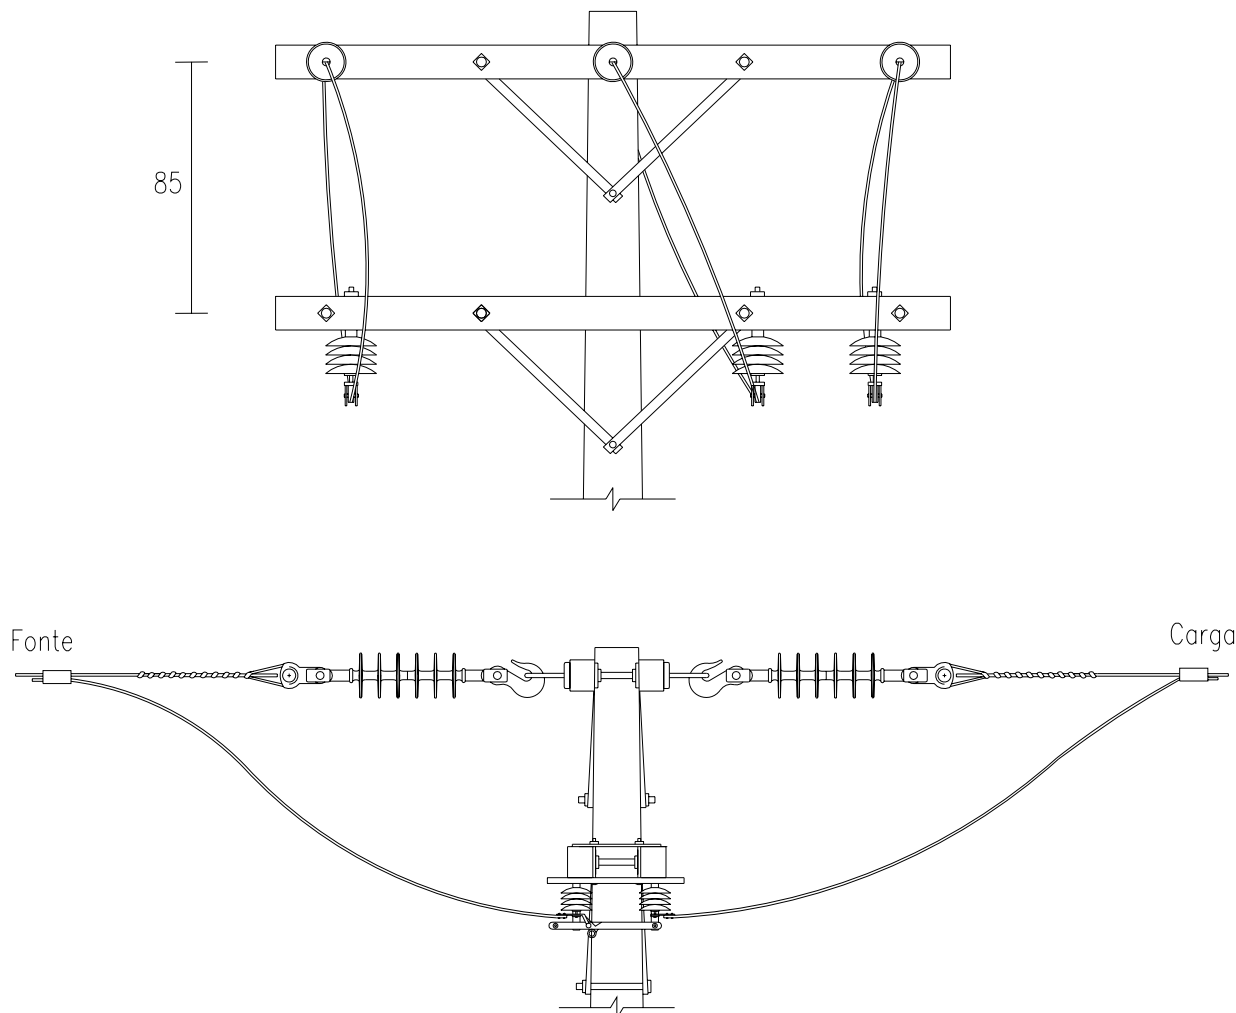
Estrutura N4 chave faca (manobra) (montagem alternativa)
